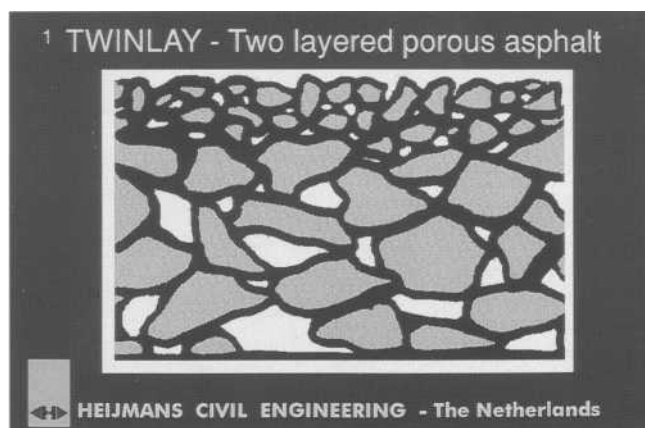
Rappresentazione schematica del doppio strato drenante (DSD)
